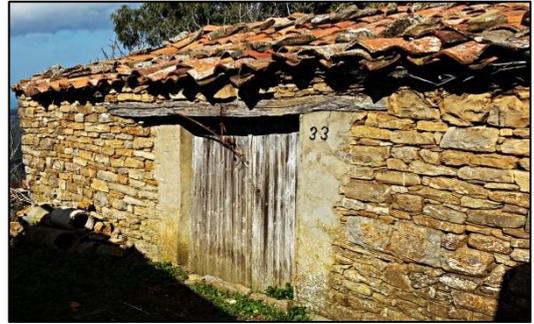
Construction en pierre (maison kabyle du village de djebbla)
